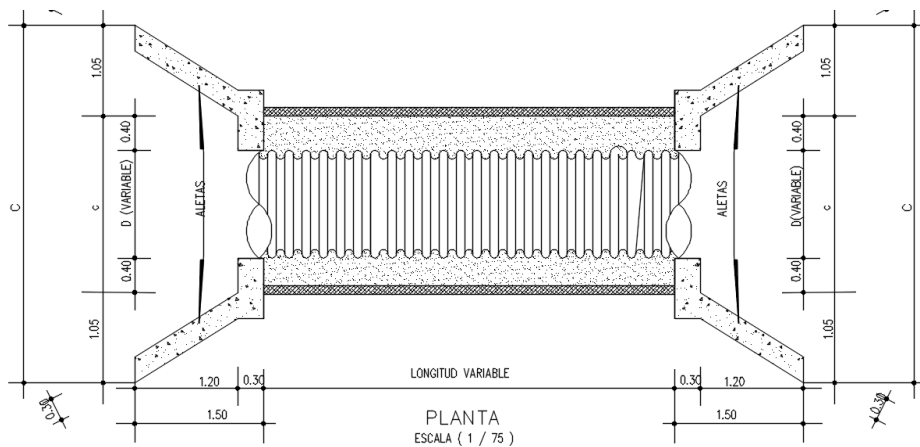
Detalle de alcantarillase debe instalar en la intersección con las vías
